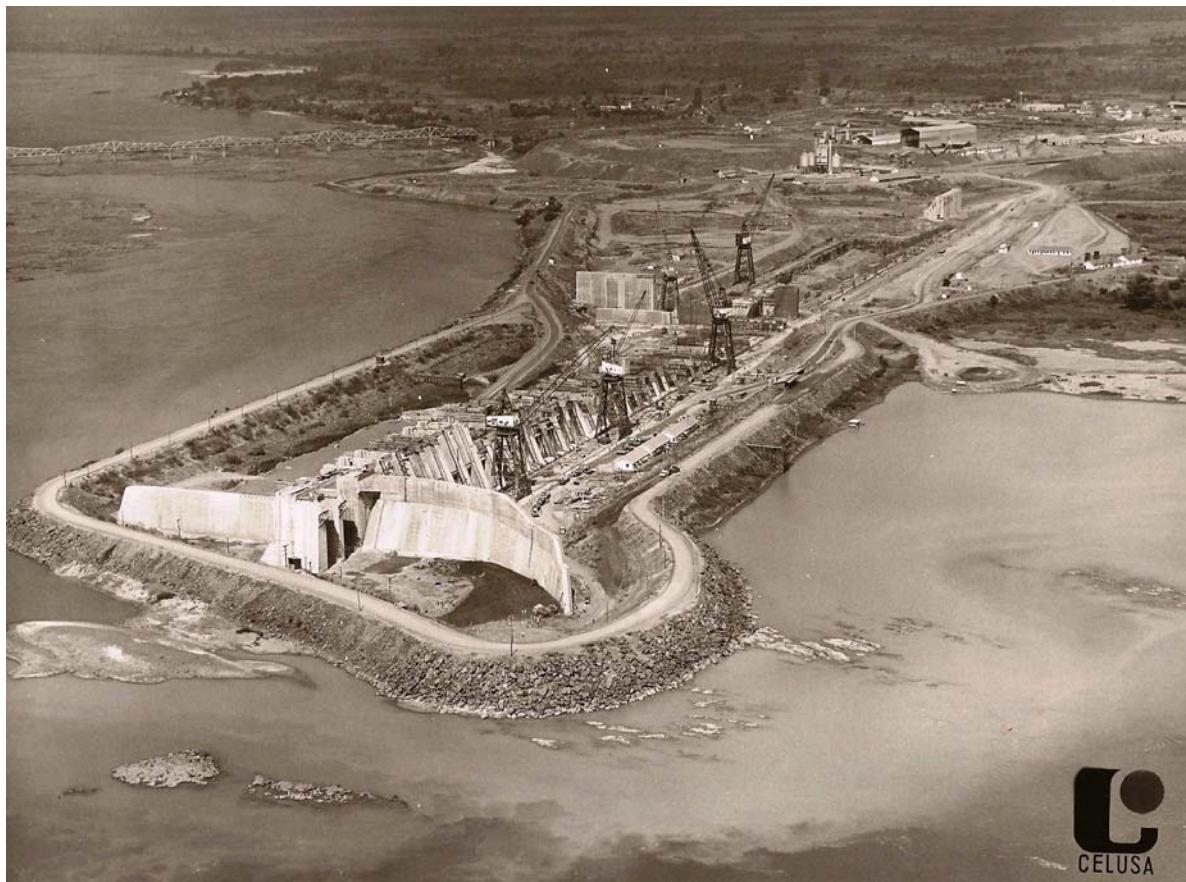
Vista aérea de Jupiá durante sua construção.
